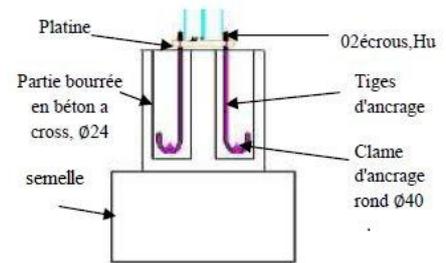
Articulation pied de poteau-fondation (1/50) Source : les auteurs 2019
